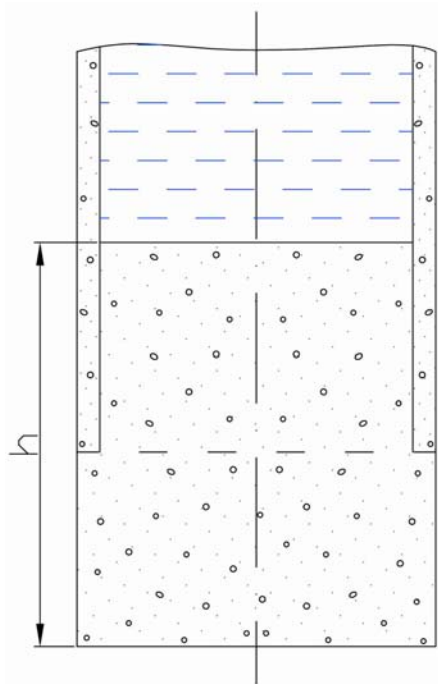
Конструкция тампонажной перемычки, сооруженной подводным бетонированием.
